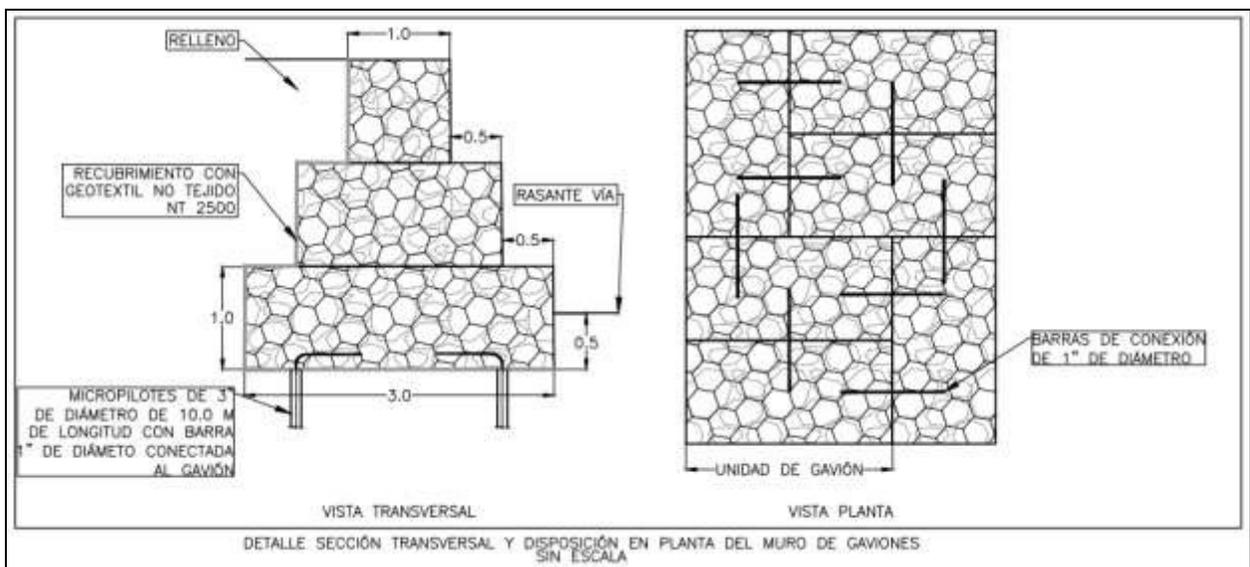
Detalle sección transversal y disposición en planta muro gavión Km 29 +200.
